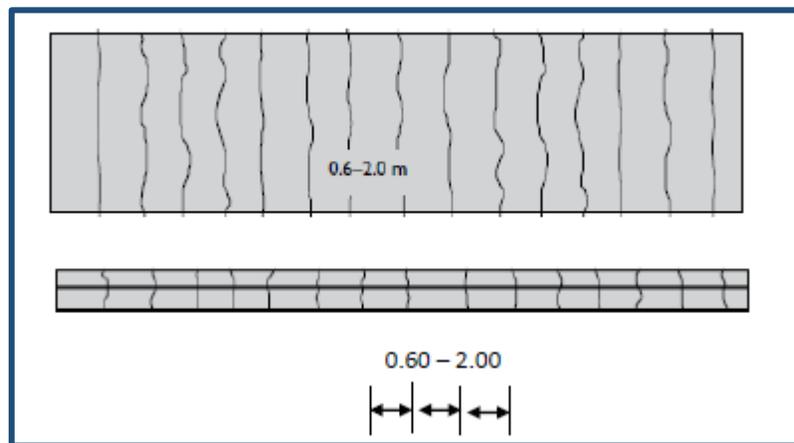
Pavimento de Concreto con Refuerzo Continuo (CRCP). (Elaboración propia).
